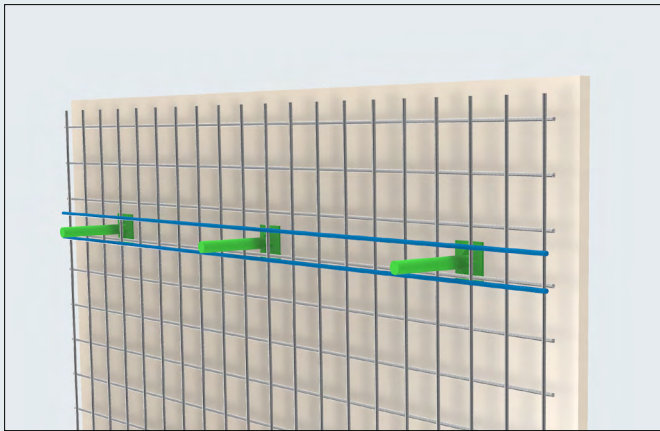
Querkraftdornhülsen auf Wandschalung montieren und Bewehrung verlegen (Abstände beachten).
